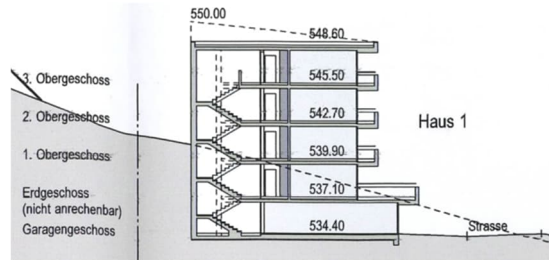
Schnitt gem. Gestaltungsplan Wendelinsmatte – Waldegg, 2009
